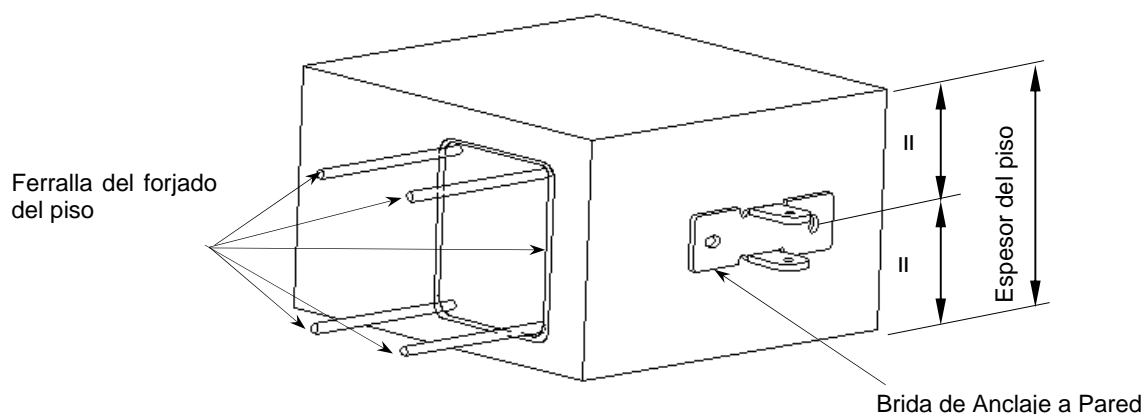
Posición de la Brida de Anclaje a Pared en el forjado
